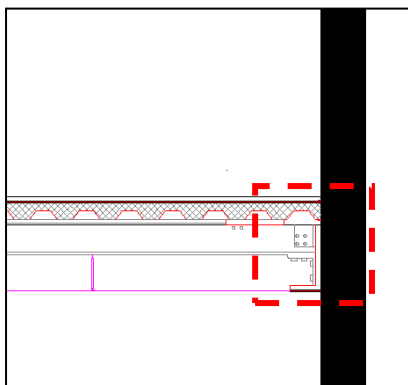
coupe illustrant le détail d'articulation poutre métallique et voile en béton armé / Source : auteurs
